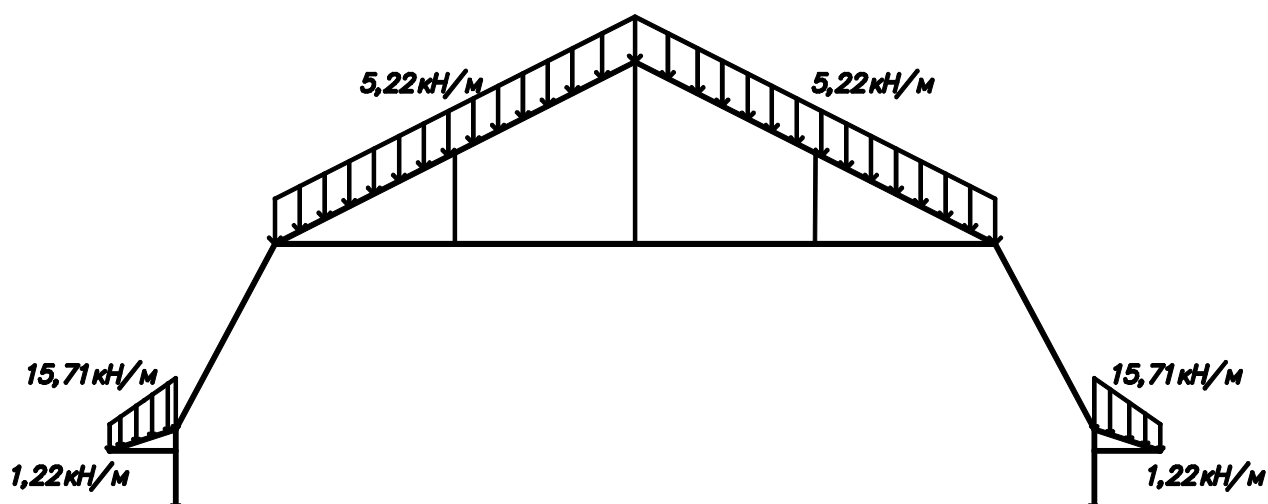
Схема приложения снеговой нагрузки (вариант 1)
